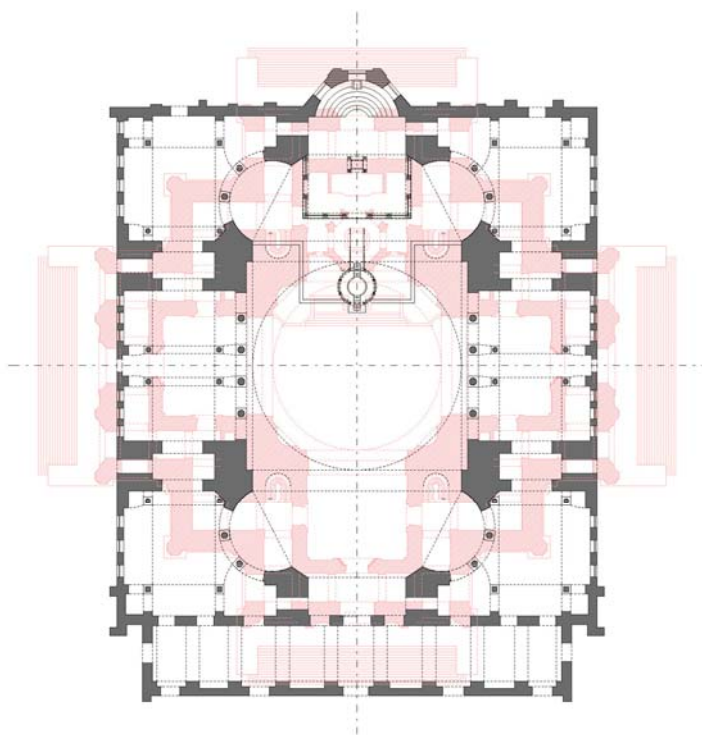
Совмещенный план первого яруса храма Св. Софии с наложенным на него в одном масштабе планом 1 этажа храма Христа Спасителя
